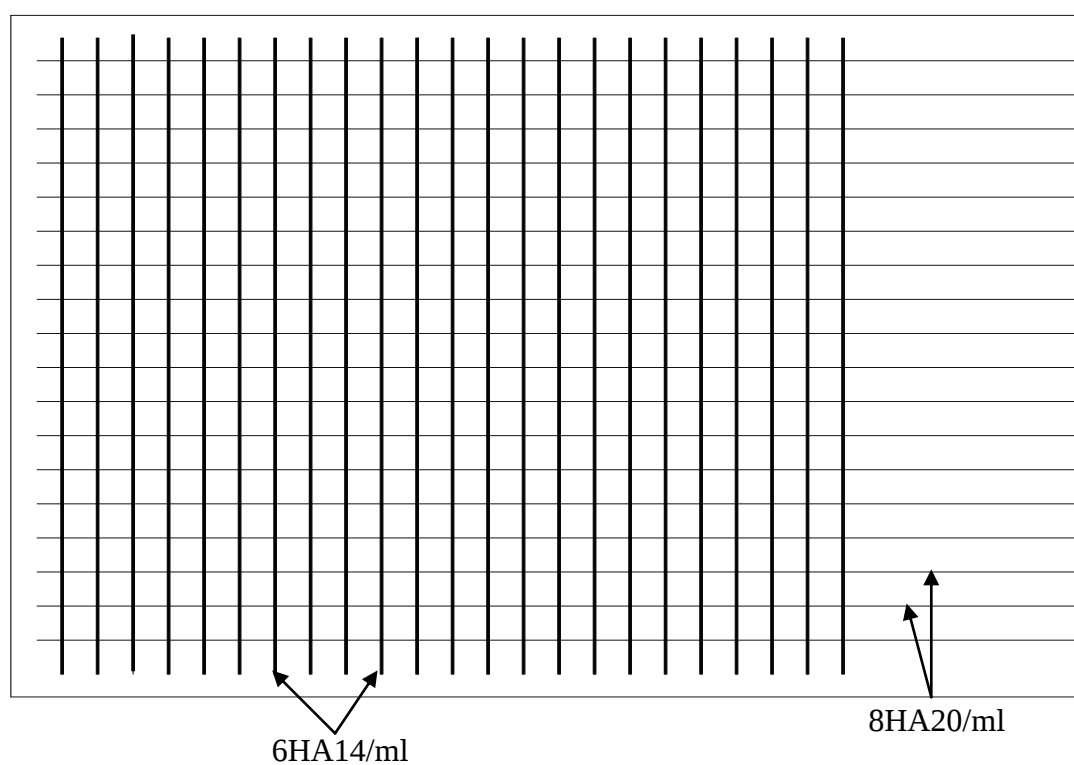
Ferrailage de la semelle (nappe supérieure)
